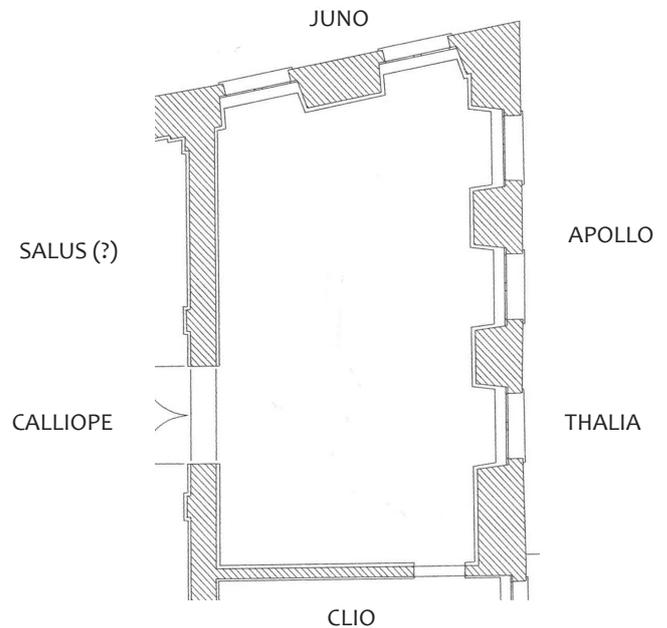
Damensalon, Grundriss, Schema mit Medaillons
